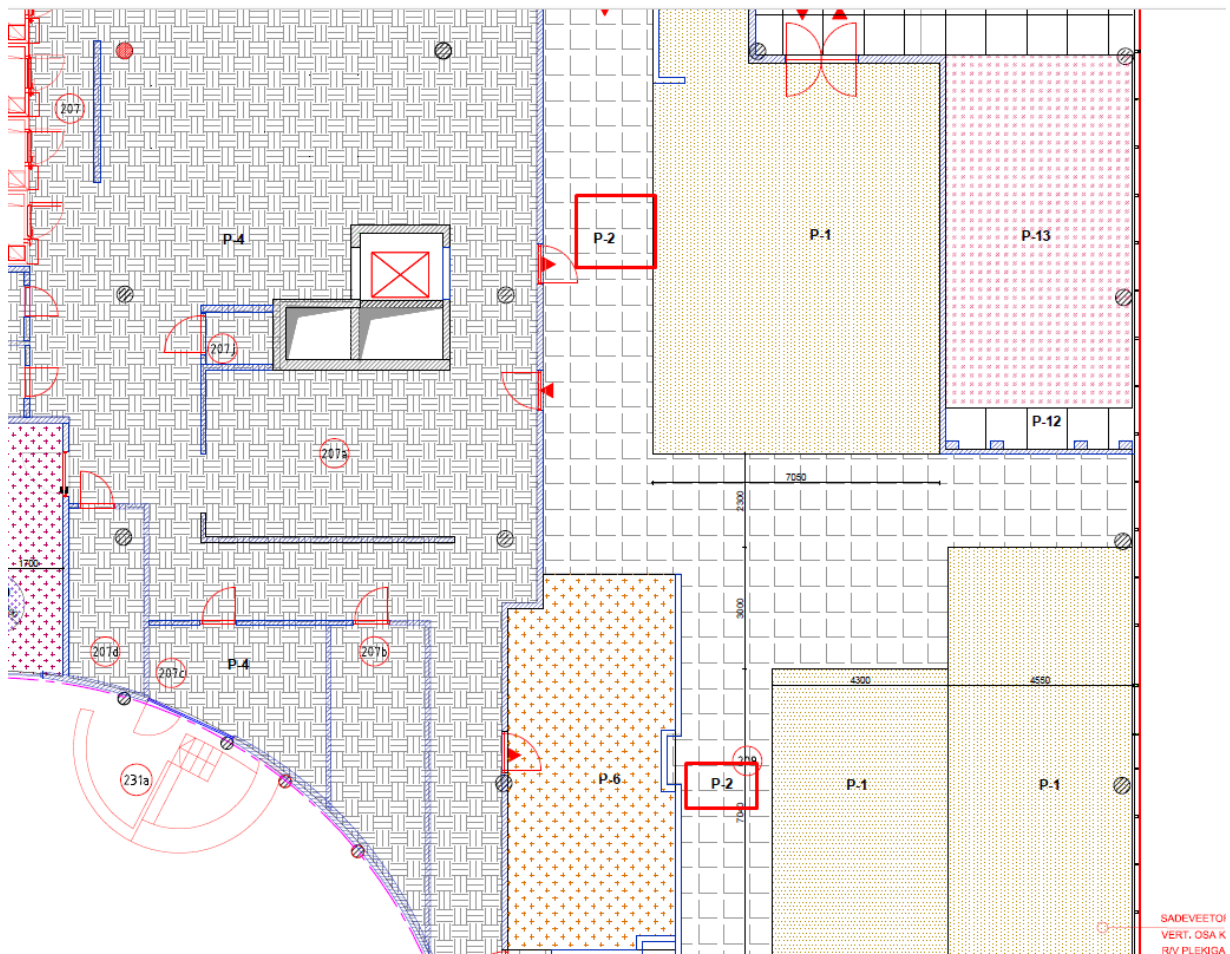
Hinnapäring betoonelemendid (Autori foto)
